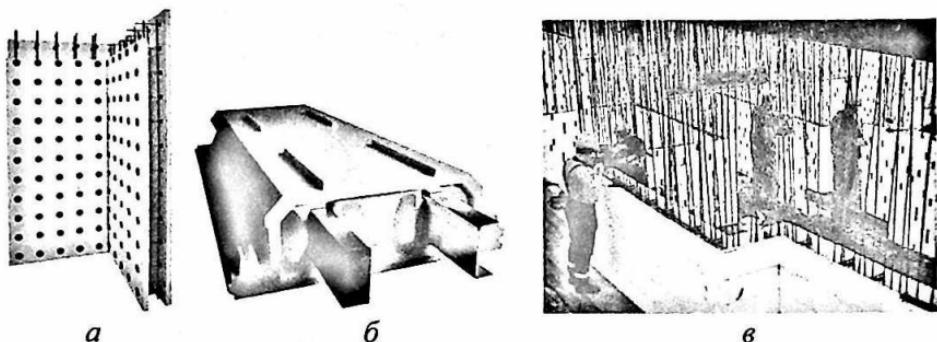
Различные варианты несъемной опалубки для стен и перекрытий на основе пенополистирола:
